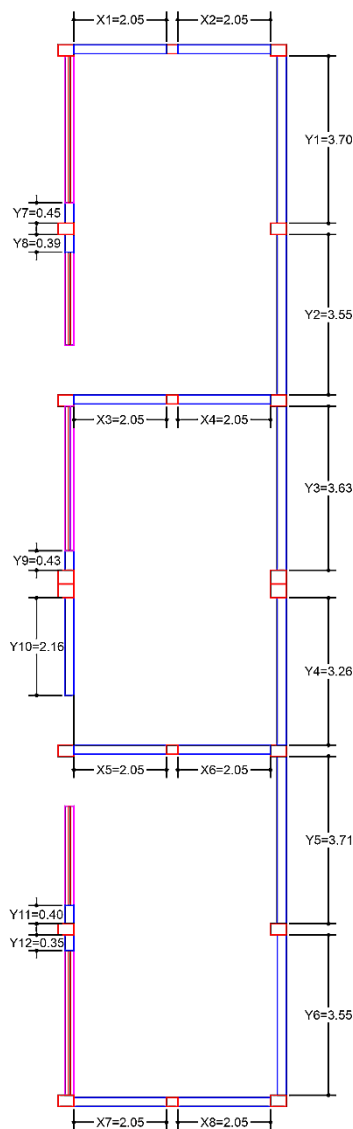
Pabellón B de la I.E. N° 055 María Isabel Rodríguez Urrunaga
